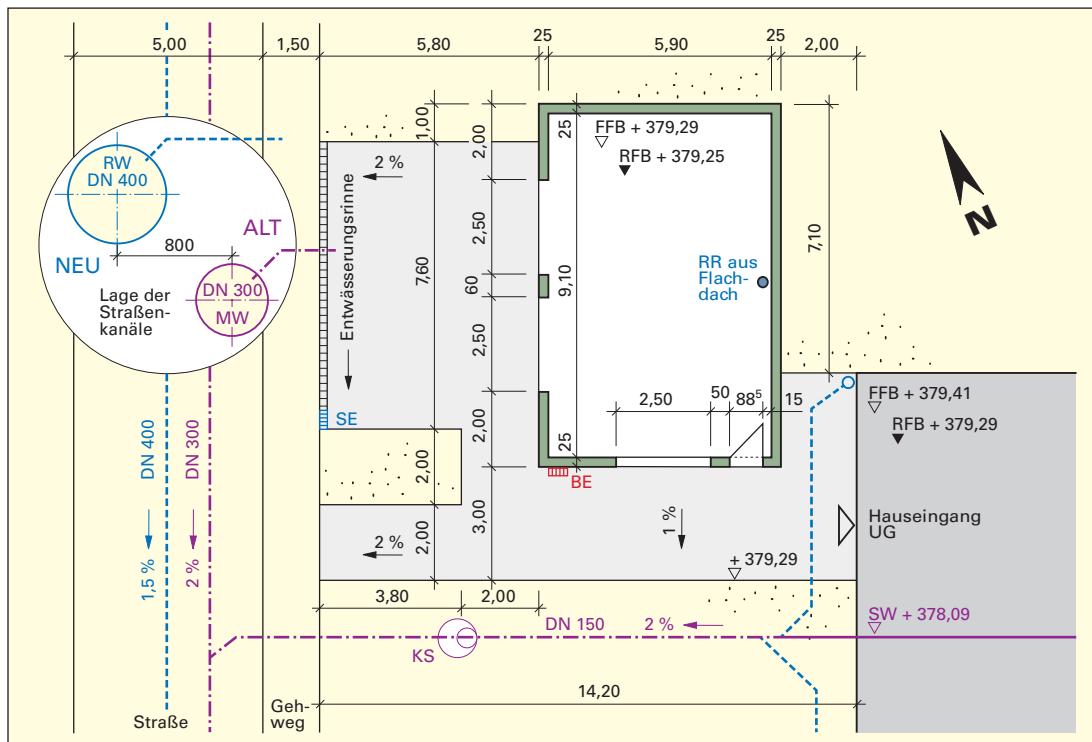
Garagen, Hauszugang, Entwässerung (Planung)
